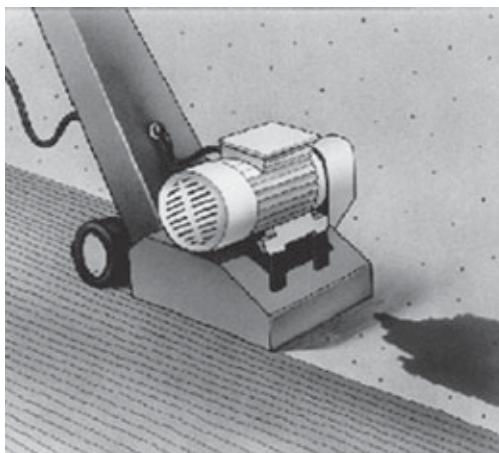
Видалення верхнього шару основи за допомогою фрезерної машини
